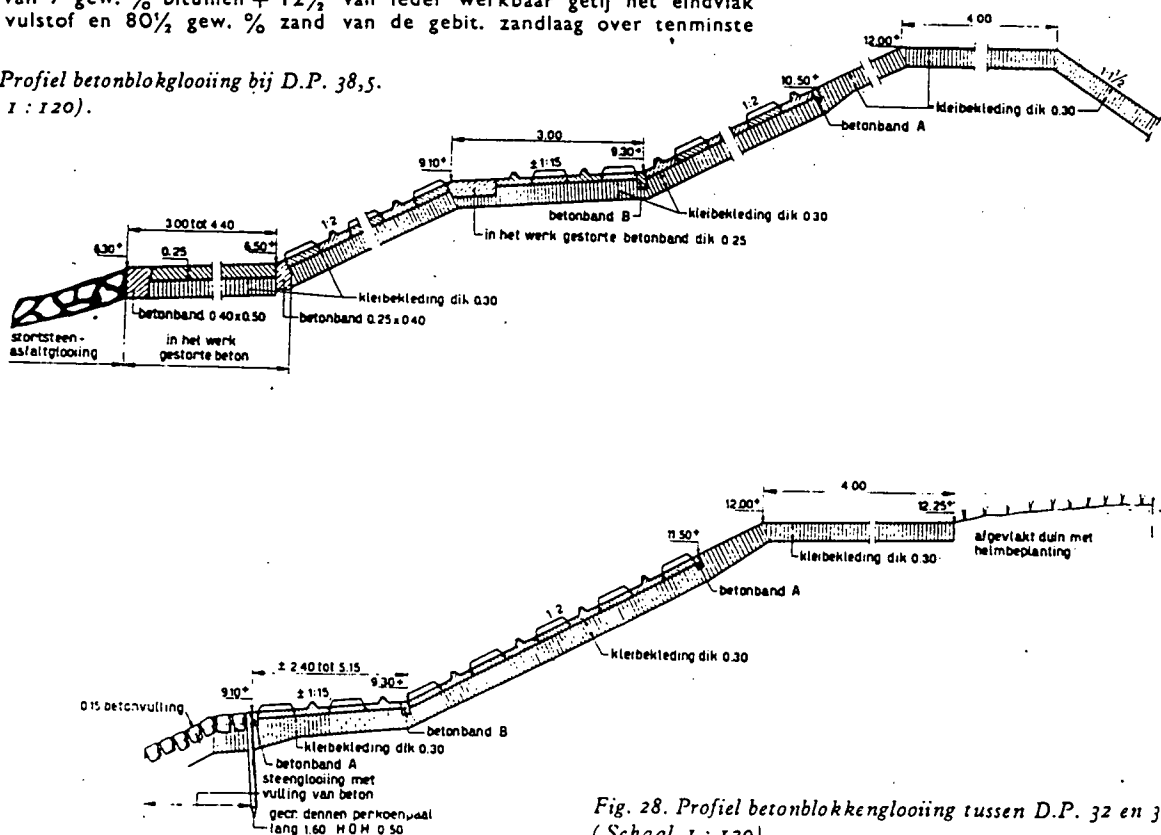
Profiel betonblokkenglooiing tussen D.P. 32 en 38. (Schaal 1 : 120).
